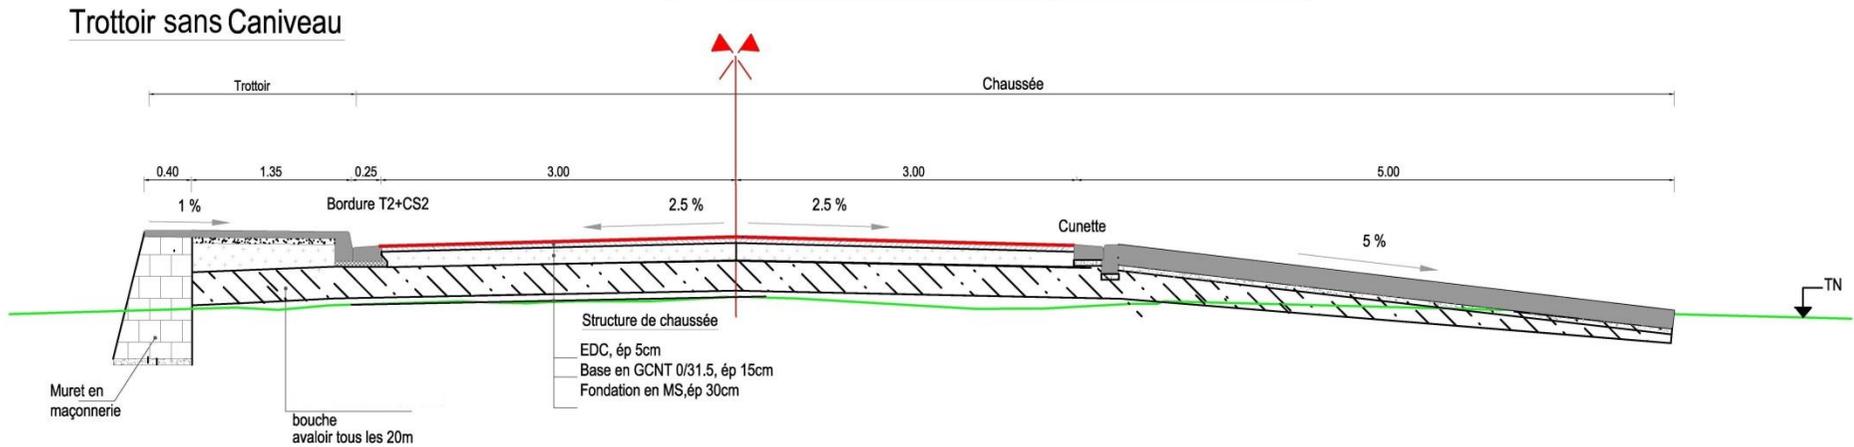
PROFILS EN TRAVERS TYPES (CHAUSSEE, TROTTOIRS AVEC OU SANS CANIVEAU)
